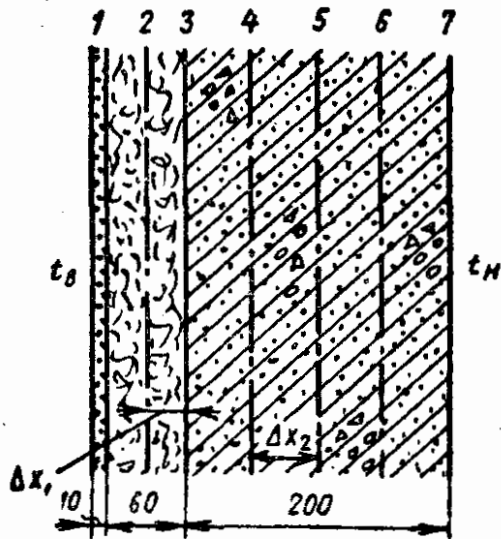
Расчетная схема бетонной стены, утепленной с внутренней стороны
